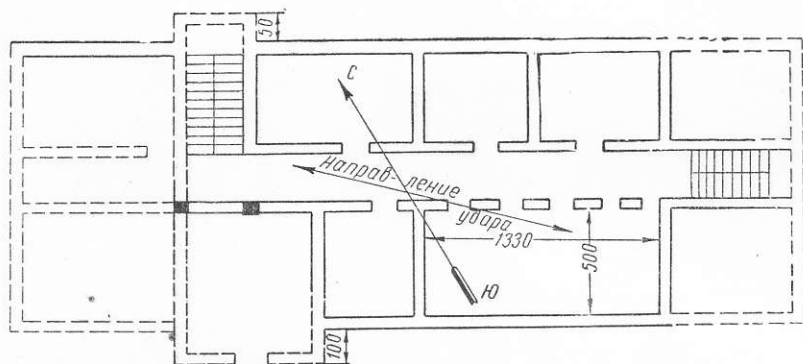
Схема плана административного здания на Ташкентской ул. (пунктиром показаны разрушенные стены)
